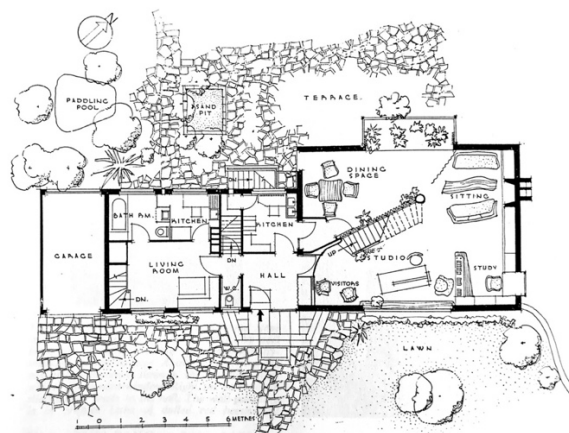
Haus P. F. Schneider, Grundriss Erdgeschoss (aus: *Building*, July 1952, p. 245)
